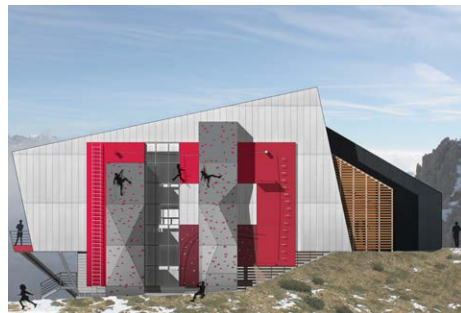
Prospetto Nord-Ovest: la parete attrezzata spicca sul profilo piatto della parete
